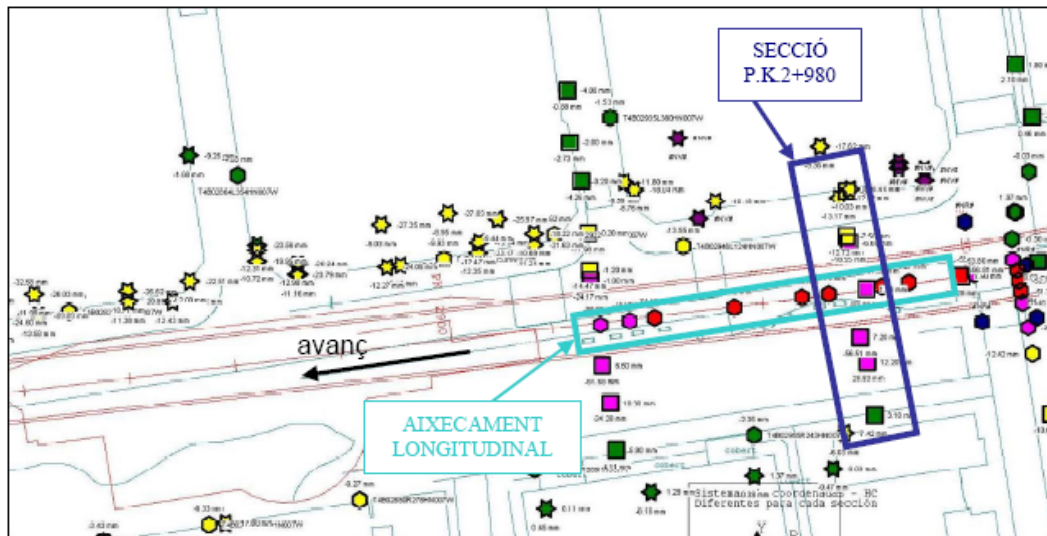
Detalle de la vista en planta de la instrumentación utilizada en la calle Sant Adrià de Barcelona, línea 9 de metro, Colomer (2007)
